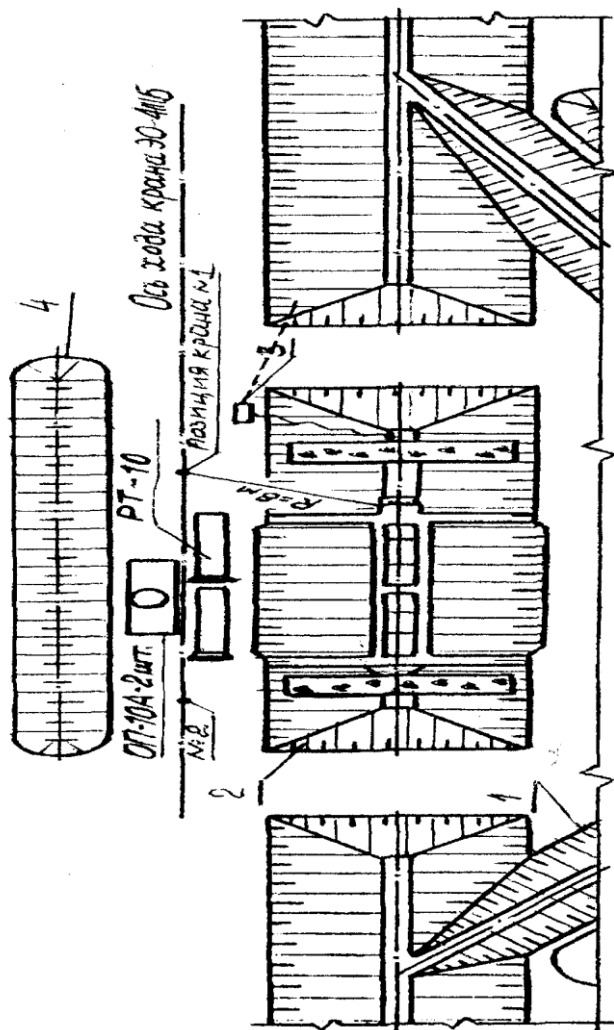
Схема производства работ по монтажу оголовков и тела трубы: 1 – обводной канал, 2 – котлован, 3 – насос, 4 – временный отвал грунта.
